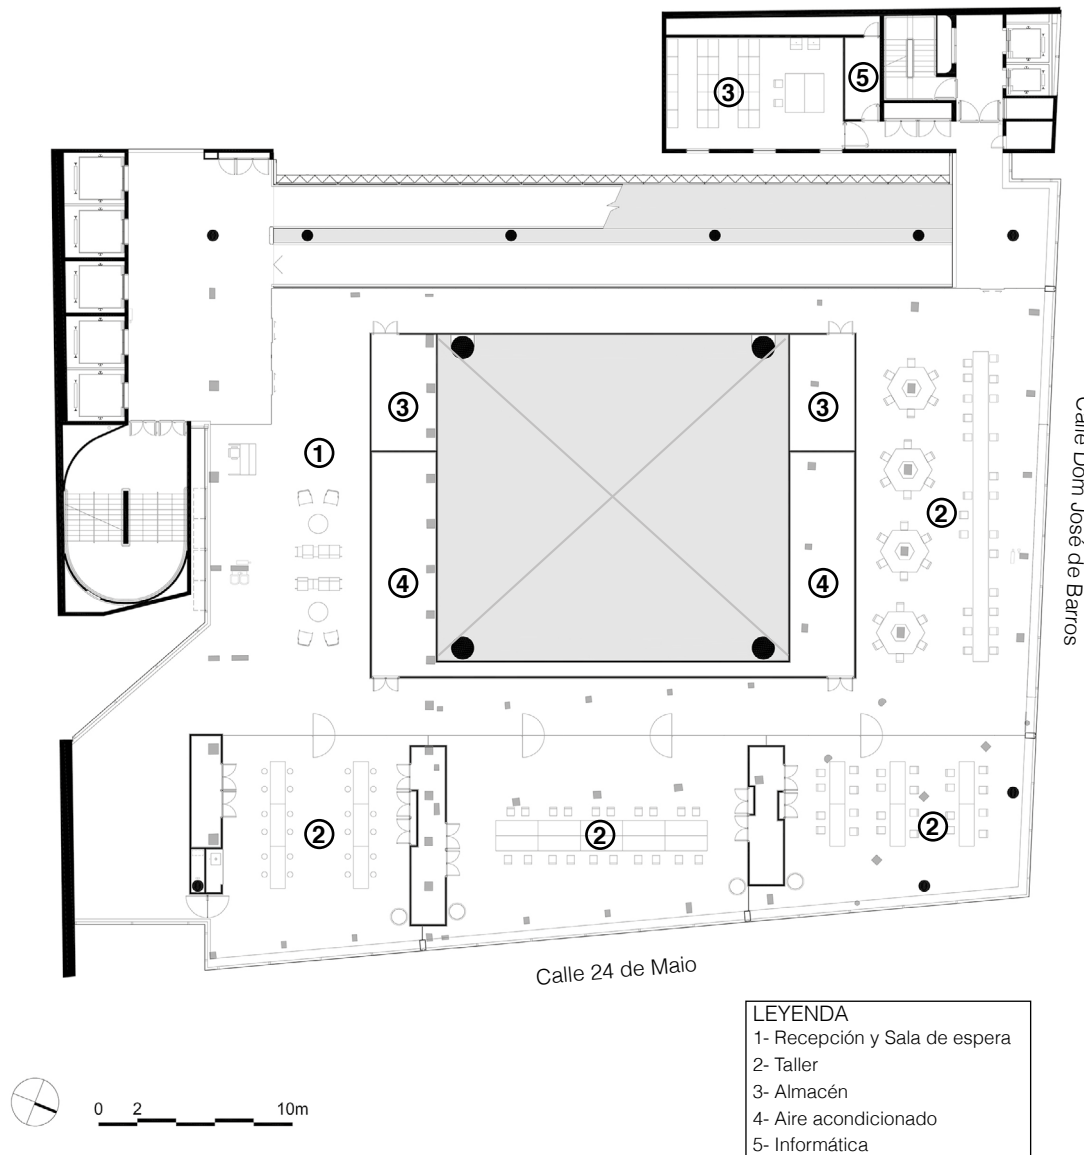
Planta Sexta del Sesc 24 de Maio. (Autoría propia. 2021. Base: MMBB Arquitectos).
